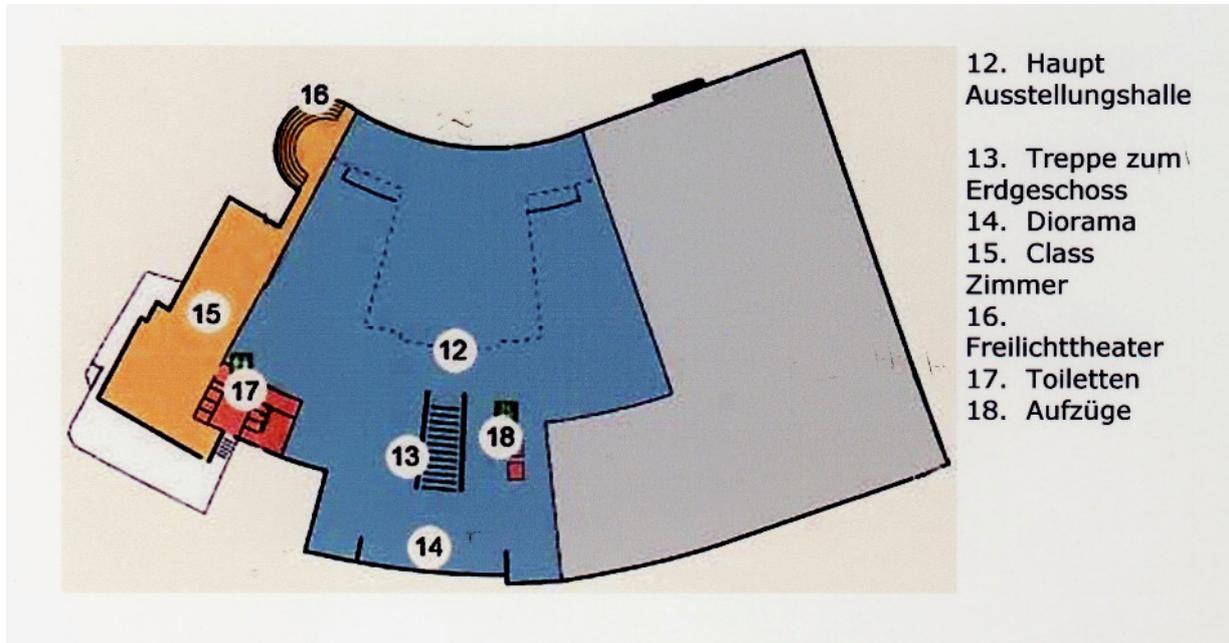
Grundriss des Nubischen Museums (Untergeschoss); Zeichnung Nubia Museum.
